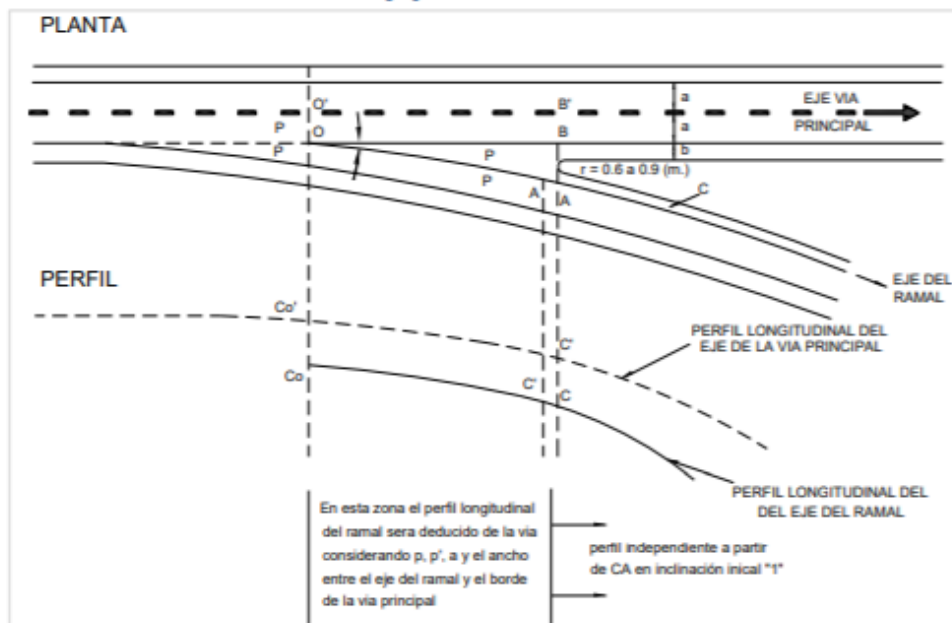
Modelo de diseño en planta y perfil de un ramal.
